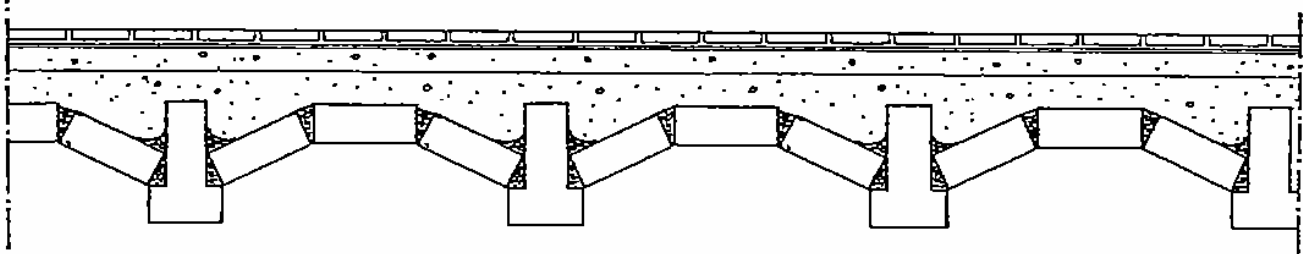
Coupe longitudinale sur le principe constructif d'entrevous en poutrelles de béton armé et blocs de terre comprimée.
